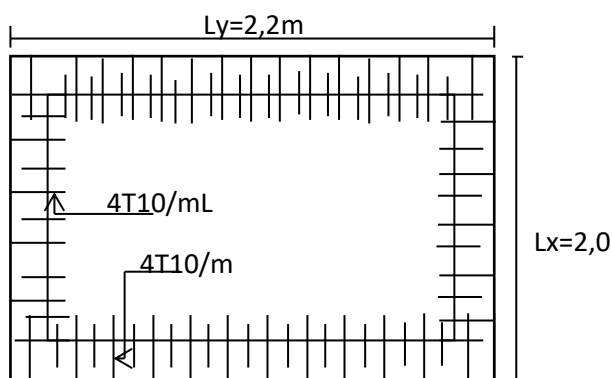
Ferrailage Supérieur du panneau de dalle –
